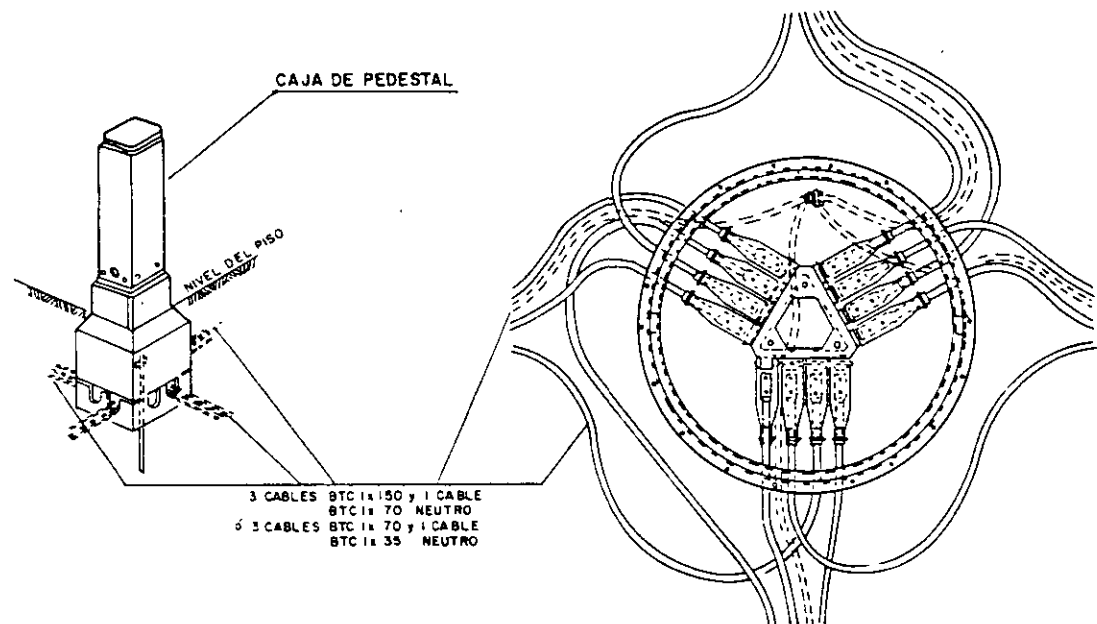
Cajas o buses de seccionamiento para redes con amarres en baja tensión, cables monofásicos aislamiento extruido.
